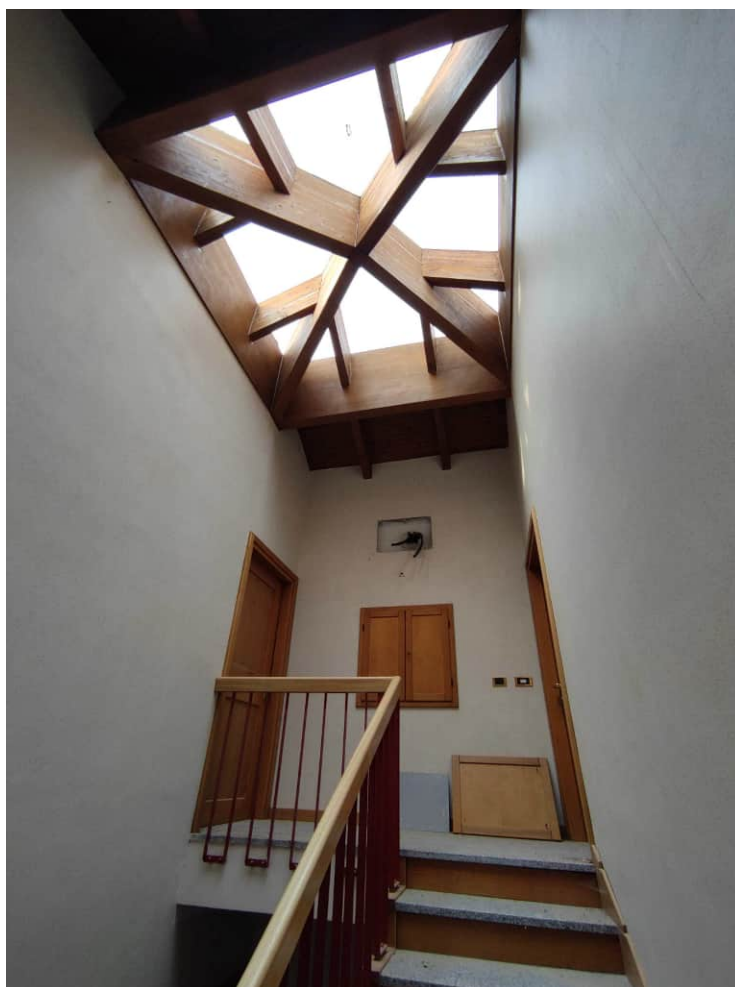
Piano terzo: spazio nord-ovest destinato a soffitta (P.M. 7).
